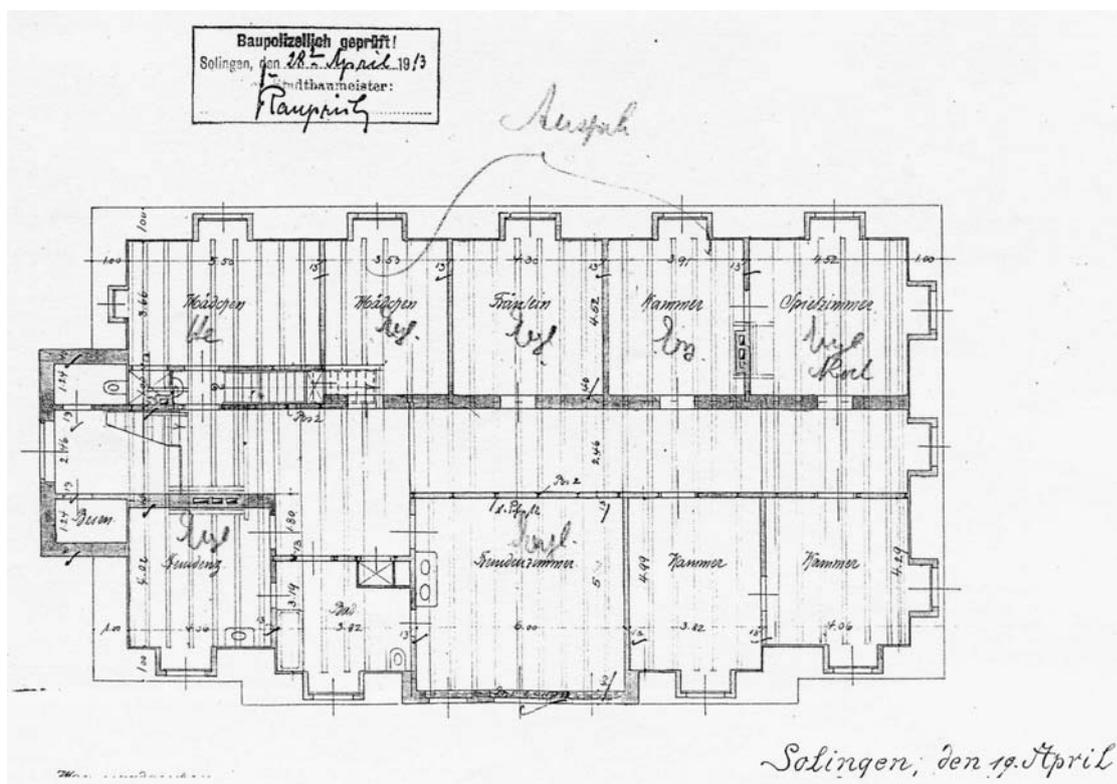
H. Plange, Grundriss Dachgeschoss, 1913
